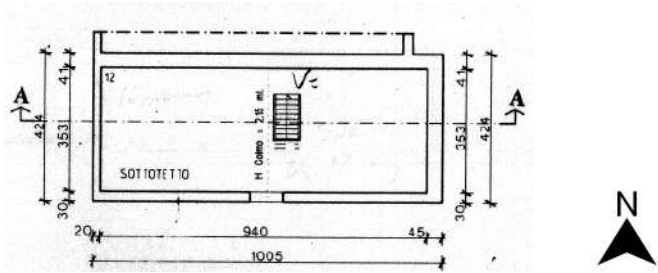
Planimetria abitazione piano sottotetto - stato approvato
